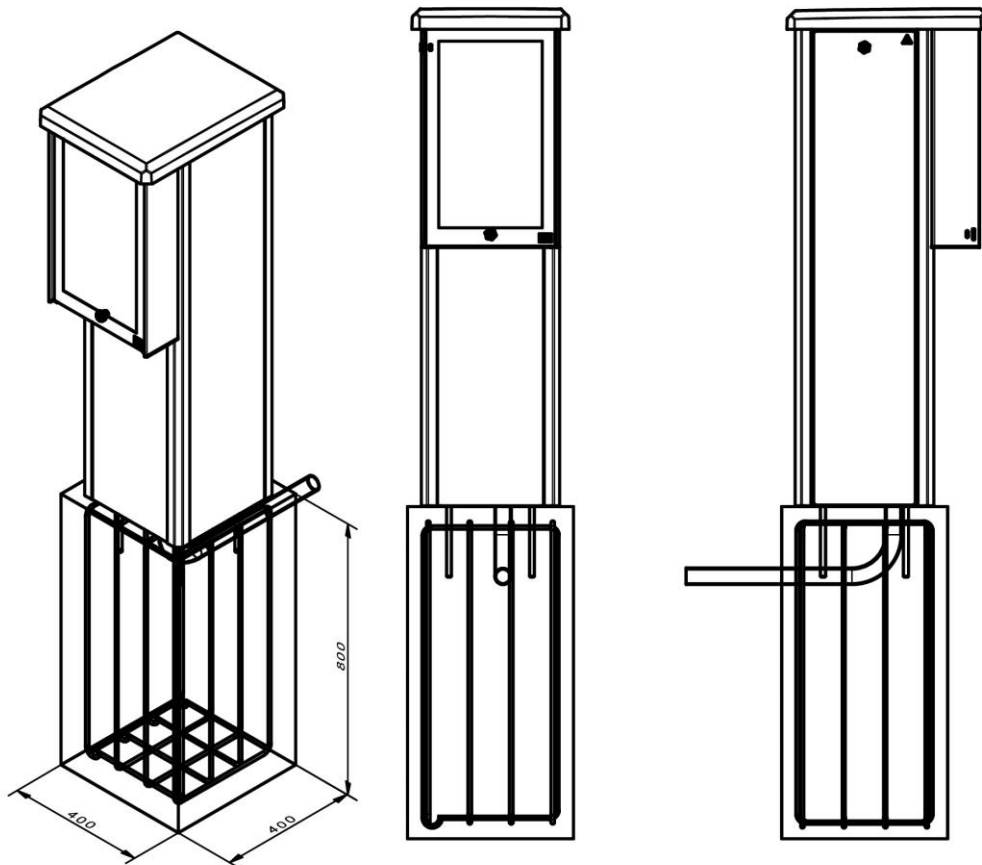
Standgehäuse PKW mit Fundament inkl. Bewehrung und Leerrohr
